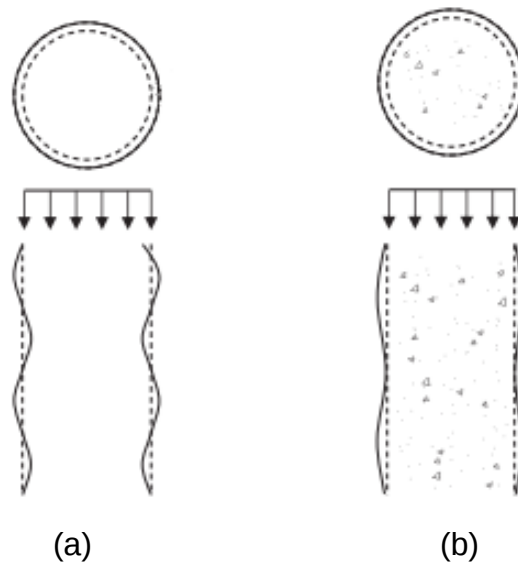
Efeito do preenchimento de concreto na flambagem local do tubo (a) Seção oca (b) Coluna mista preenchida [21]
